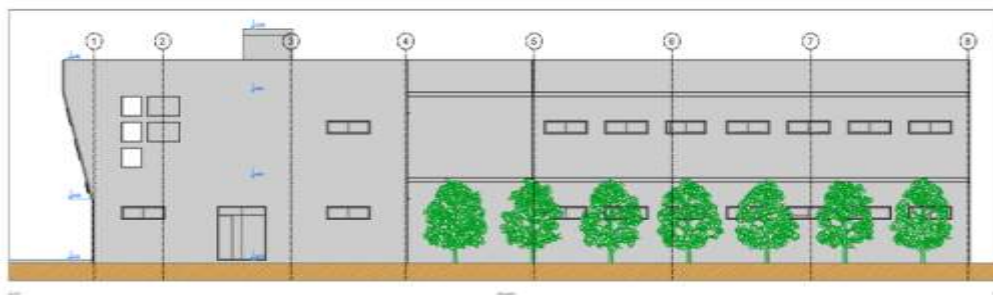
Elevación de Fachadas Laterales - Arquitectura
